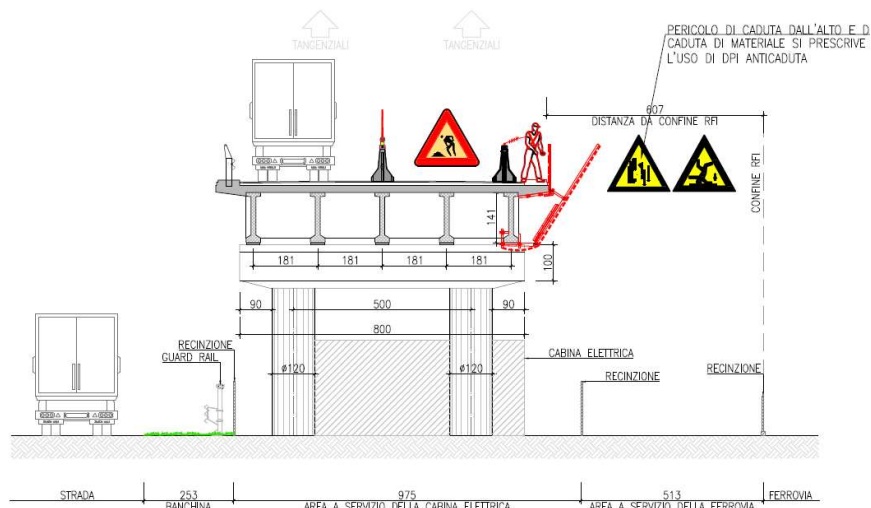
Sezione tipo di cantierizzazione (FASE 1) in affiancamento a viabilità locale
